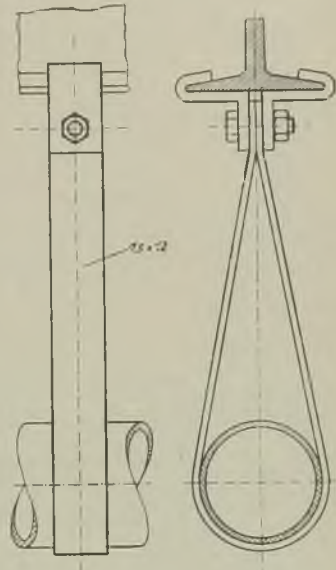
Rohrbefestigung an Beton-decke mittels langer Bandeisen-Bänder (besonders für Heizung).
